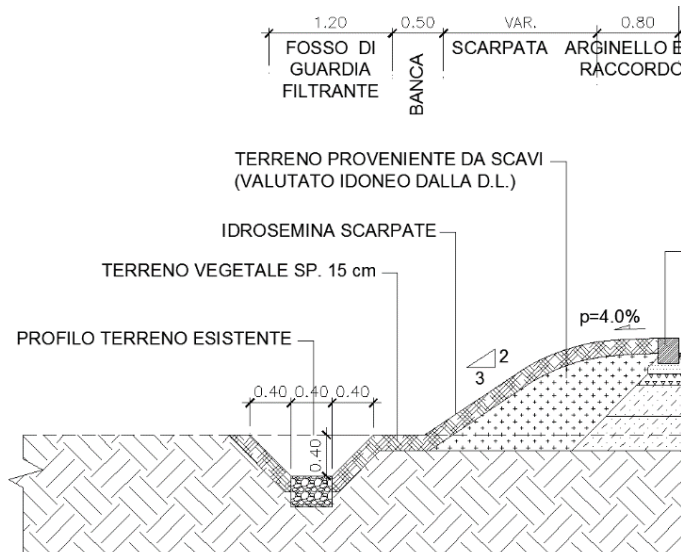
Dettaglio fossa di guardia di progetto, strada in rilevato
